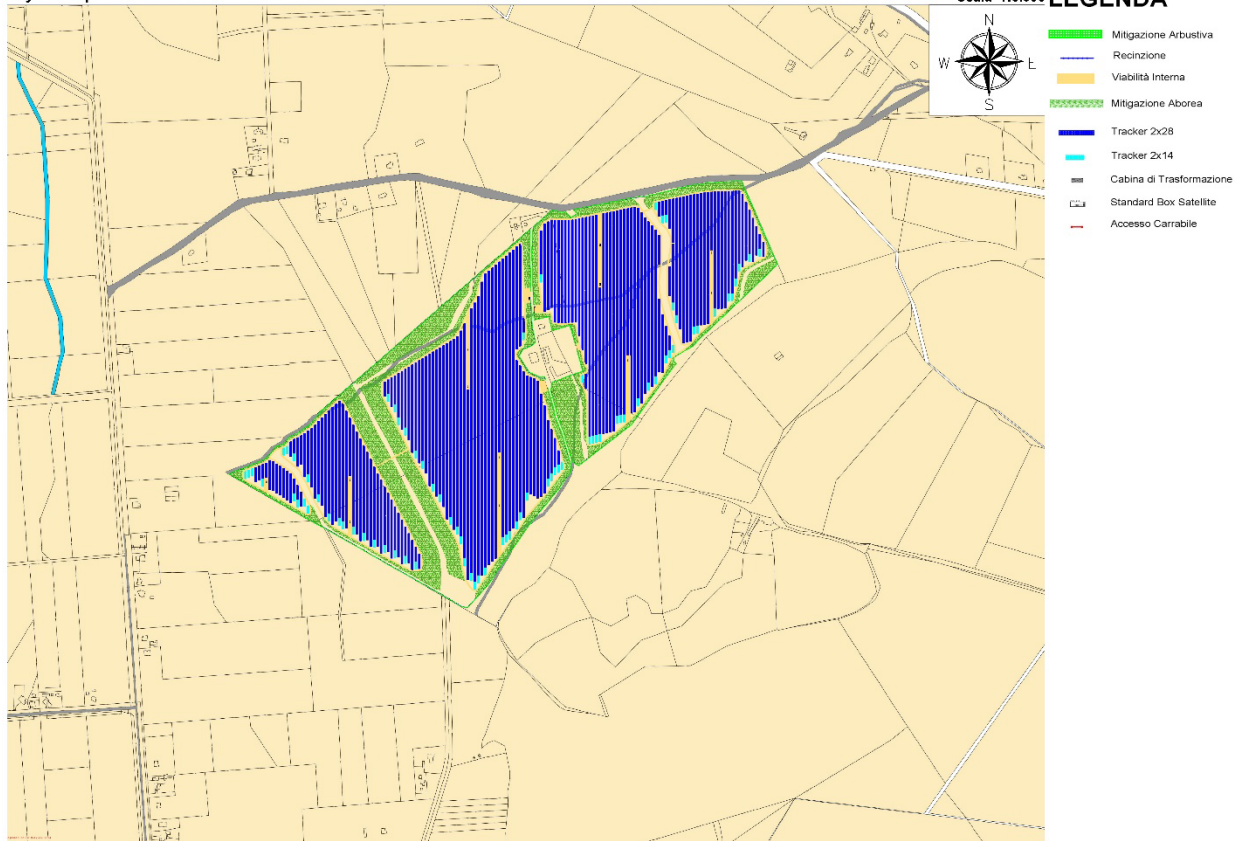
Layout del futuro impianto FV_ SANTA MARIA LA PALMA su Catastale
